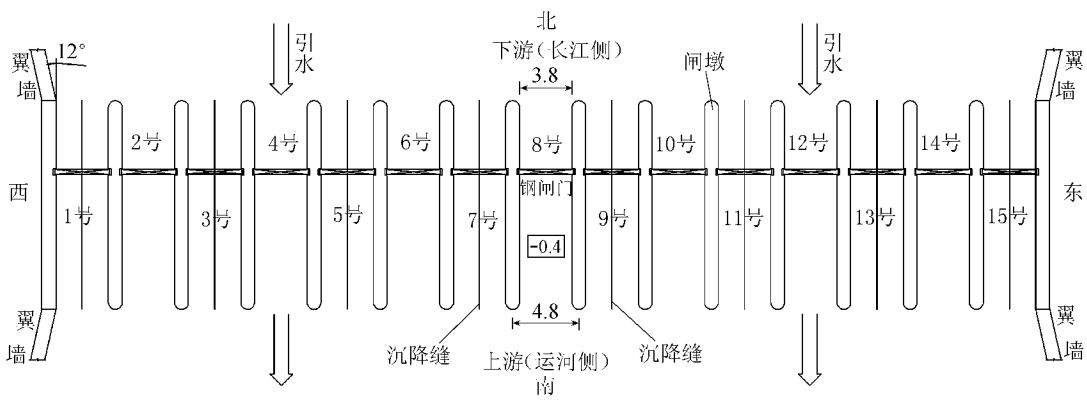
闸底板、闸墩、门槽平面布置示意图(单位:m)
